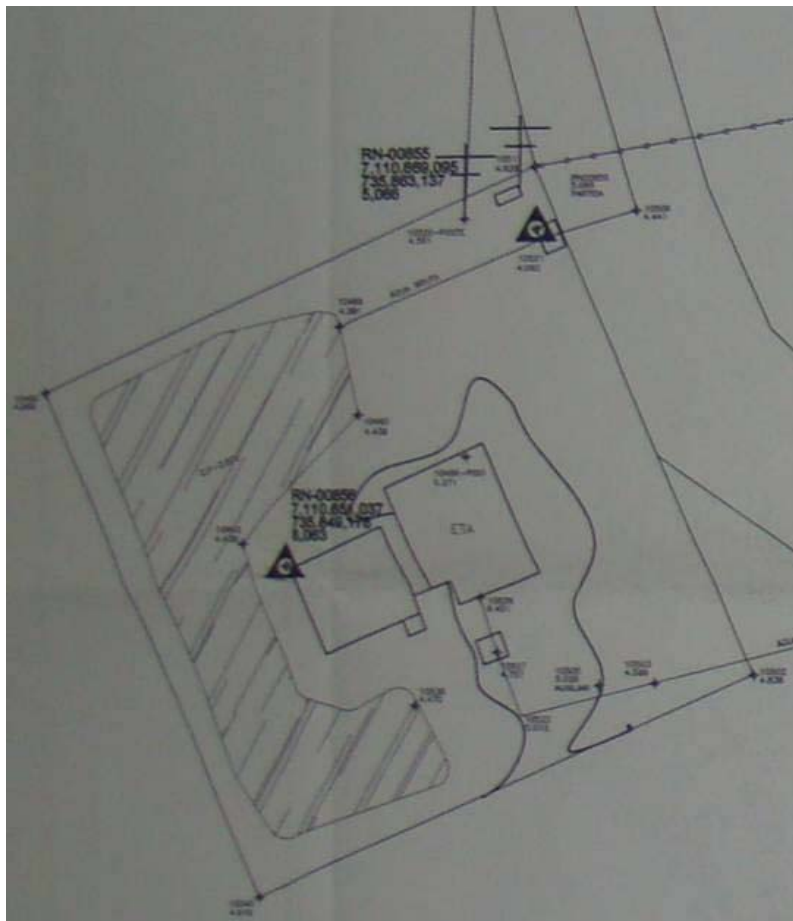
Planta Baixa – Layout da Estação de Tratamento de Água
